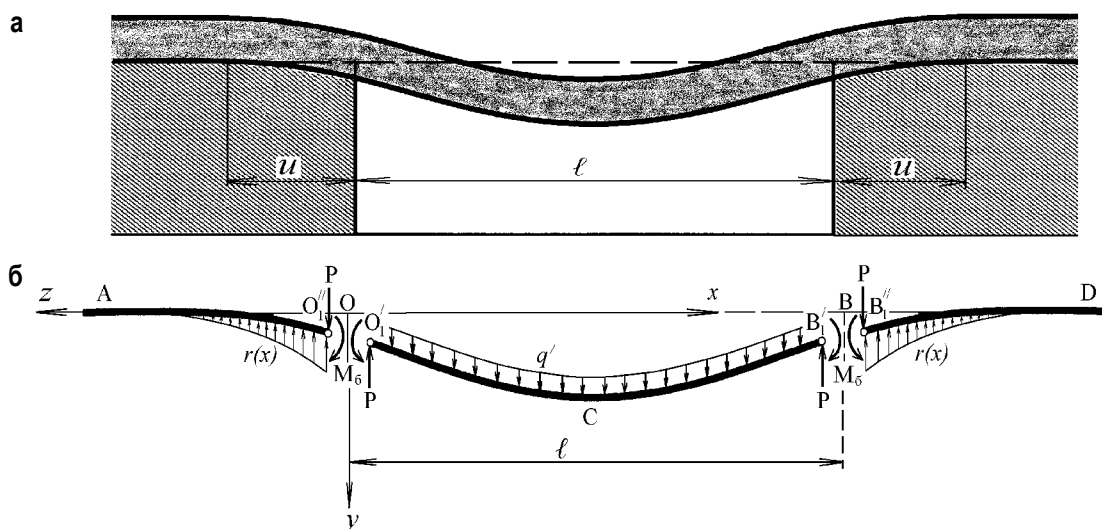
Влияние податливости опор на характер деформирования кровли подготовительной выработки: а – общий вид; б – расчетная схема
